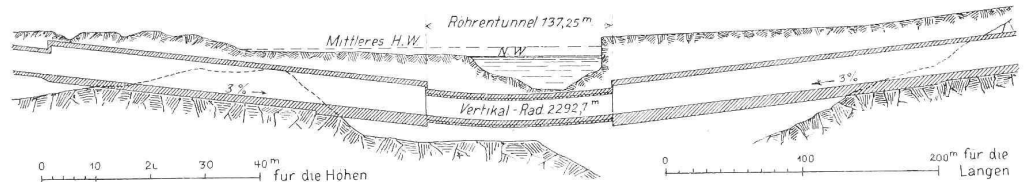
Untergrundbahn. — Längsprofil des Tunnels unter dem Harlemfluss. — Masstab 1 : 5000 f. d. L., 1 : 1250 f. d. H.
